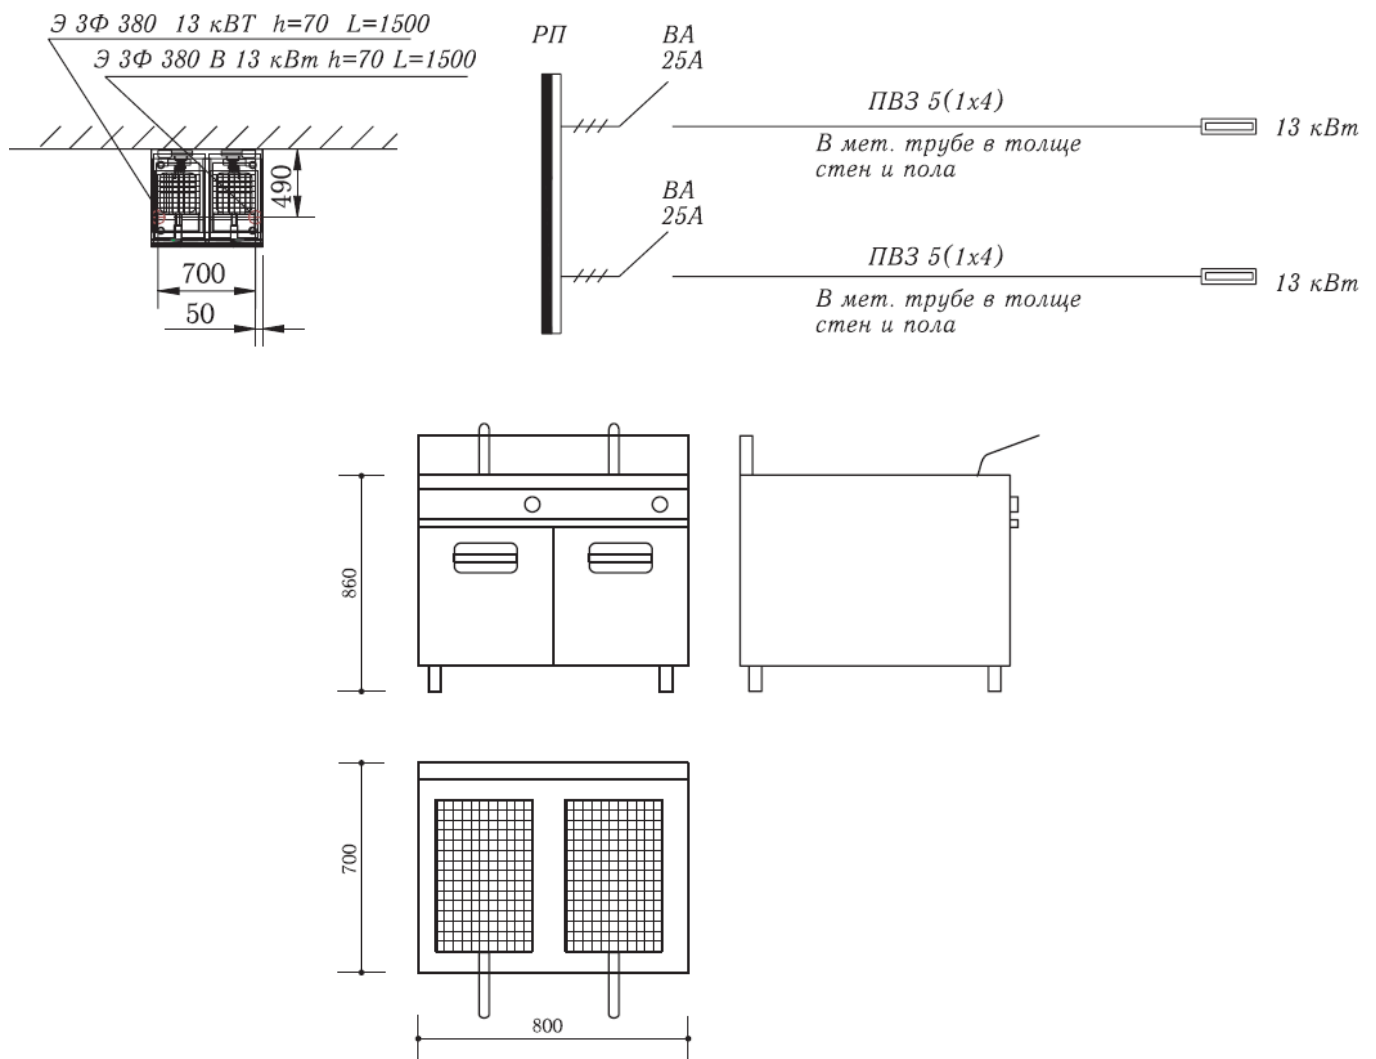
Схема подключения и габаритные размеры напольной фритюрницы Olis 74/02 FRE
